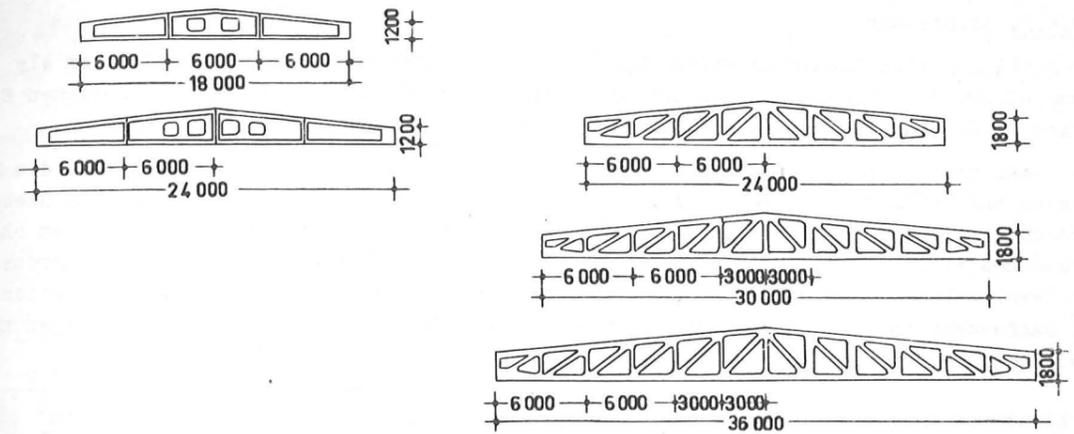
Spannbeton-Satteldach-Vollwand- und Fachwerkbinder, zusammengespannt, DN 10 %
